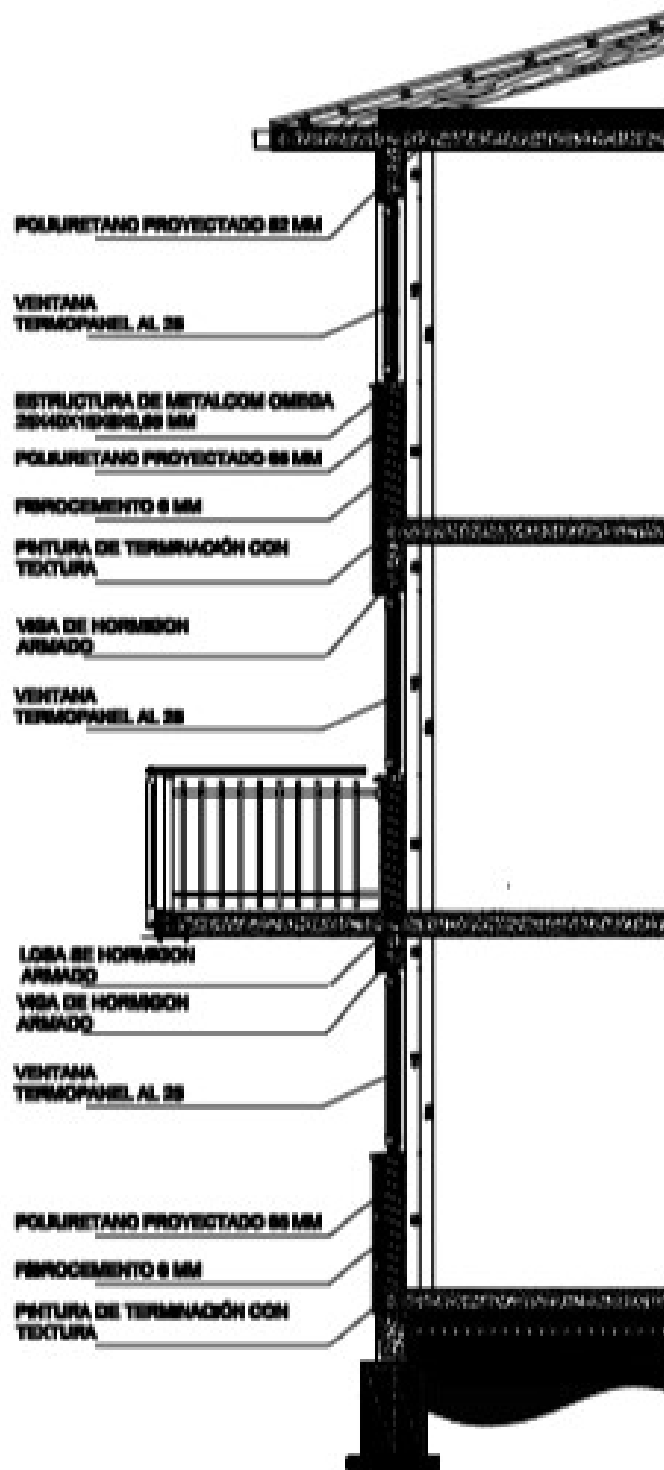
Alternativa N°5. Poliuretano Proyectado en Techo y Muros.
